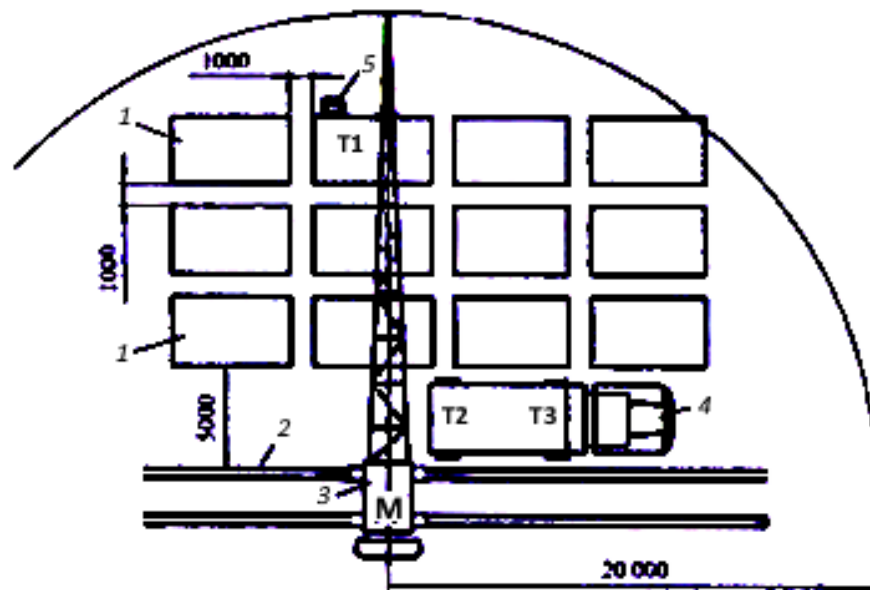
Технологічна схема навантаження плит перекриття складу баштовим краном БКСМ-14ПМЗ у напівпричеп-балковоз УПР-1212: 1 - штабелі плит перекриття; 2 - підкрановий шлях; 3 - баштовий кран; 4 - тягач із напівпричепом; 5 - дерев'яні сходи; М, Т1, Т2, Т3 – робітники: місця машиніста крана та такелажників
